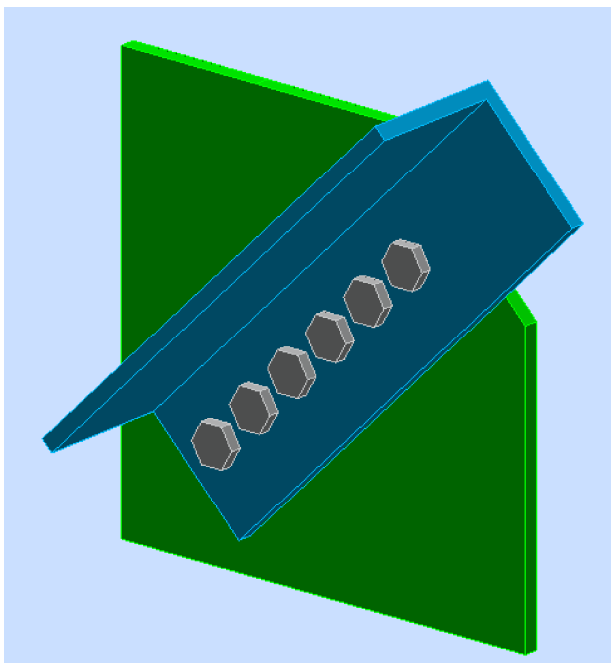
Vue perspective de l'assemblage montant 2 / diagonale 6.
